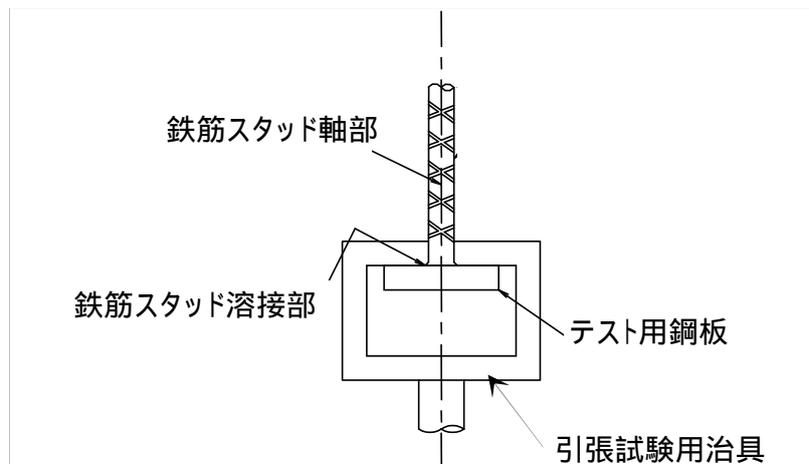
鉄筋スタッド溶接部の引張試験方法の例
